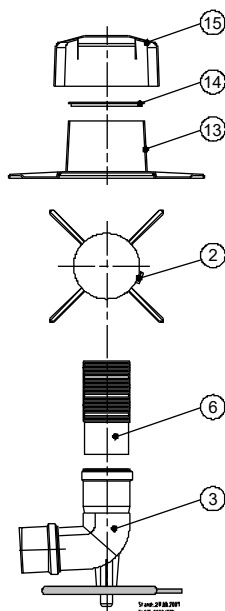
Detail-Zeichnung Befestigung Schachtabdeckung
